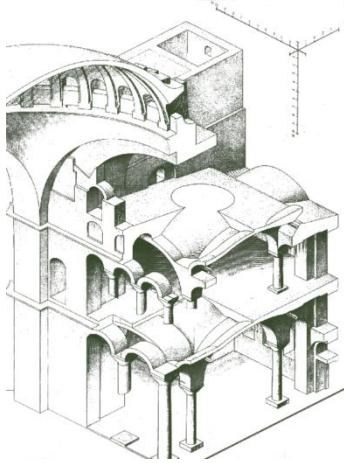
Corte de vista interior Santa Sofía (tirantes)
